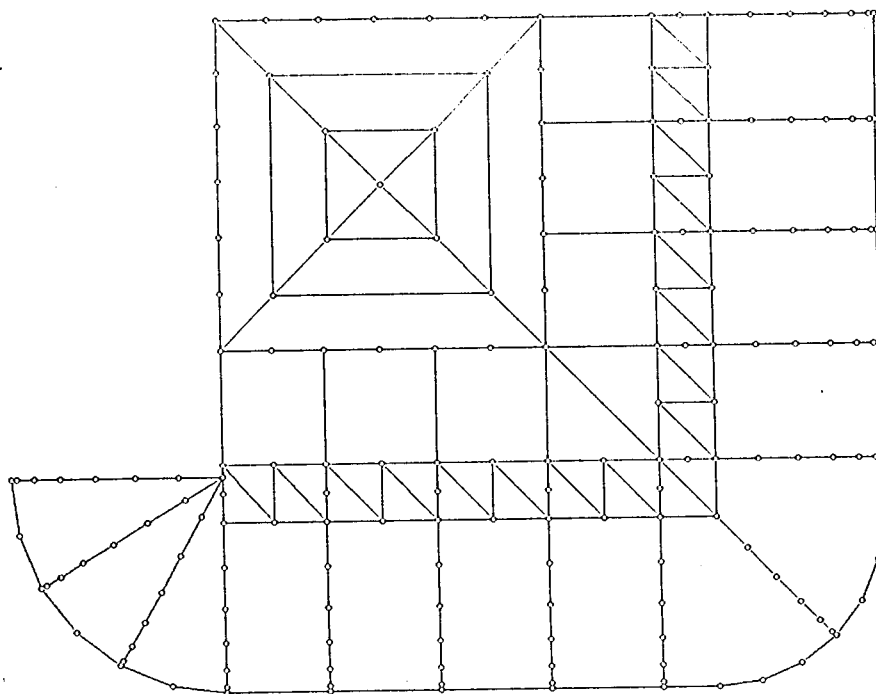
Shopent. Modelação estrutural: planta.
